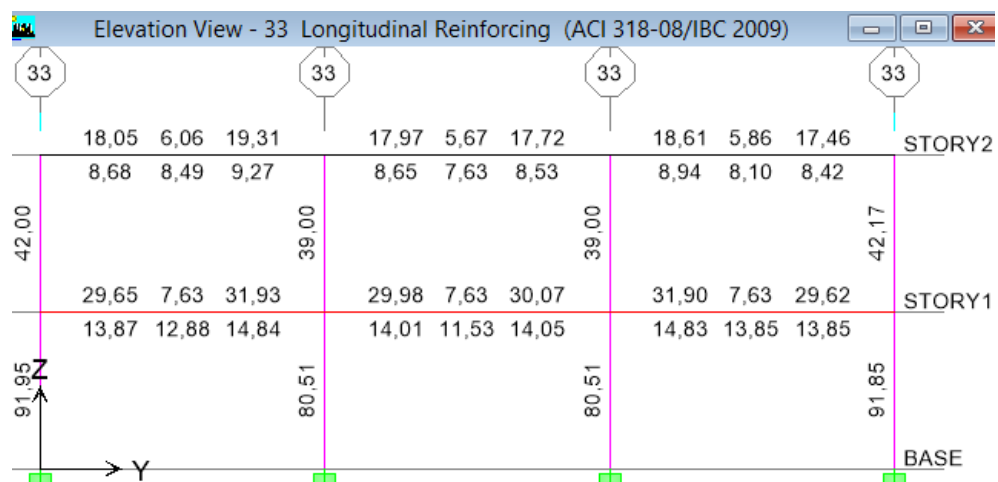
Acero en Vigas y Columnas en el Pórtico 33 – Obstetricia- (NEC-11)
